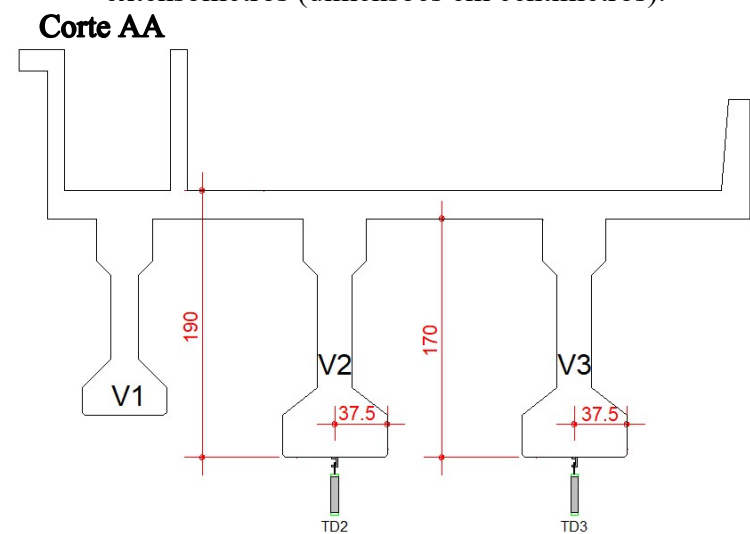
Posicionamento em corte dos transdutores de deslocamento (dimensões em centímetros).
